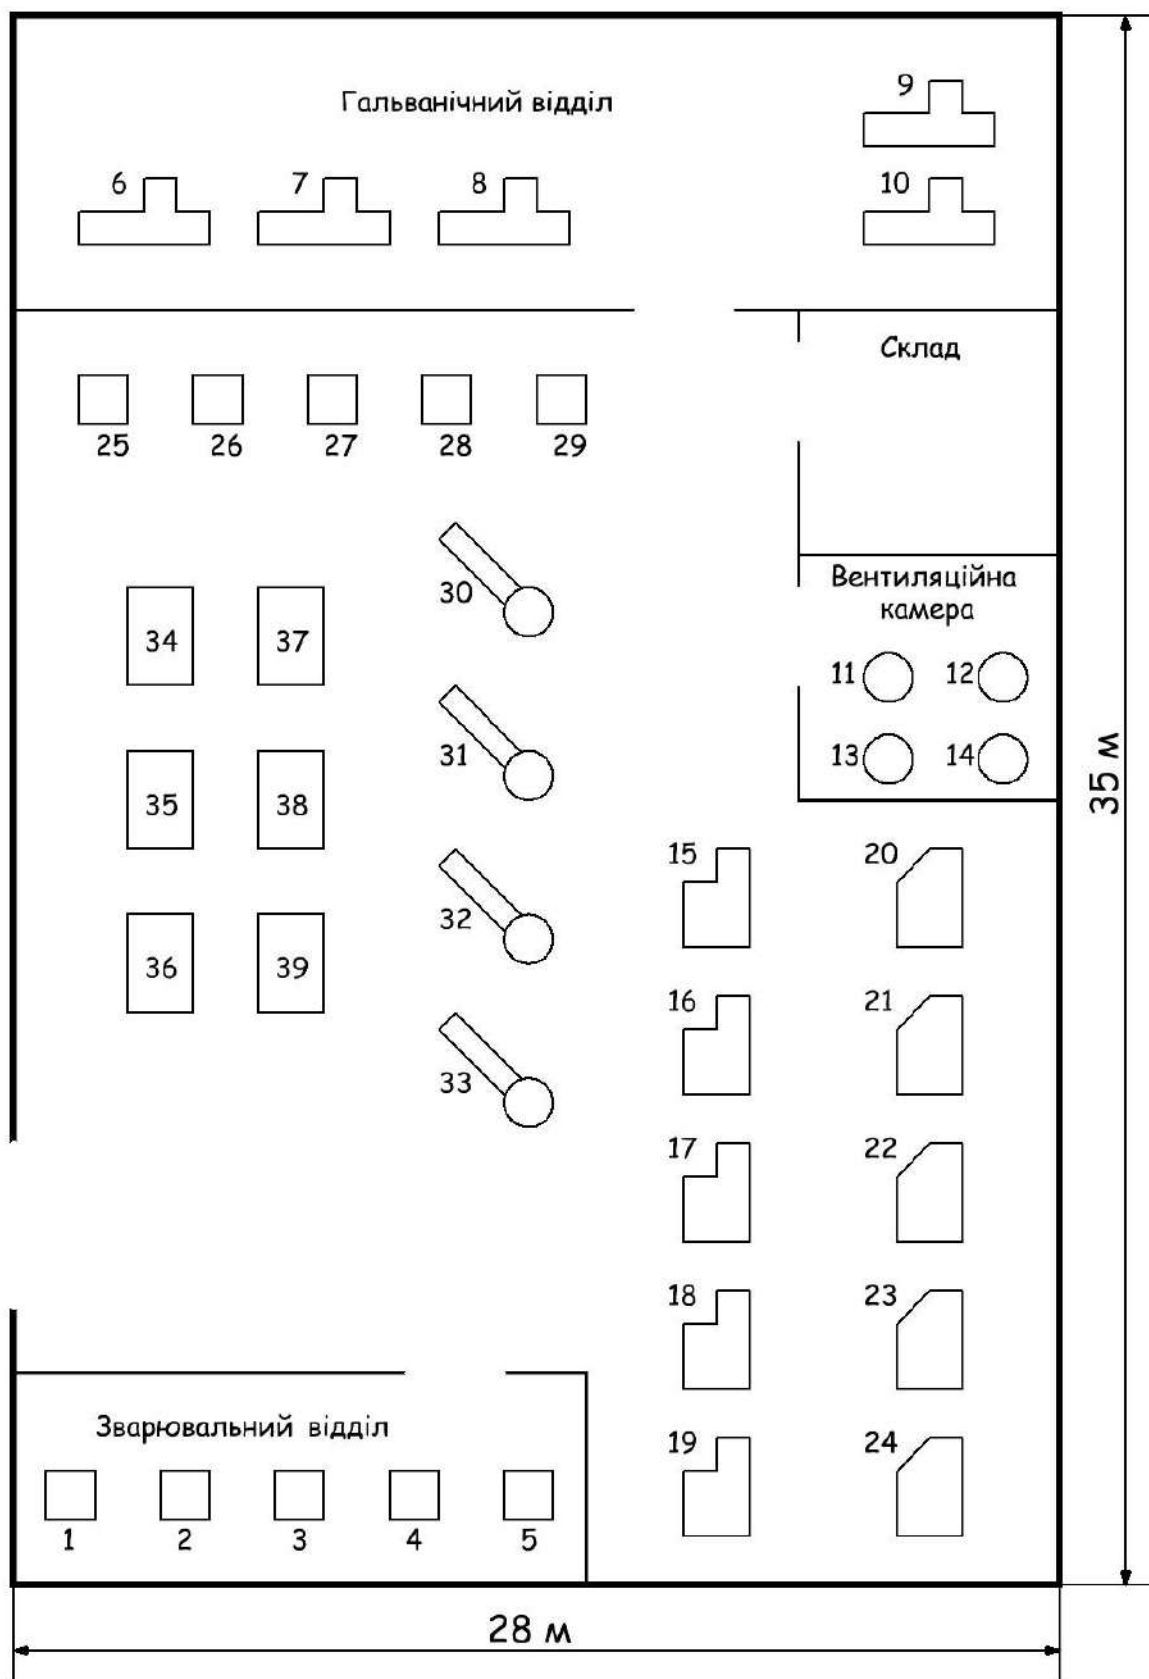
План розміщення ЕП цеху обробки корпусних деталей
